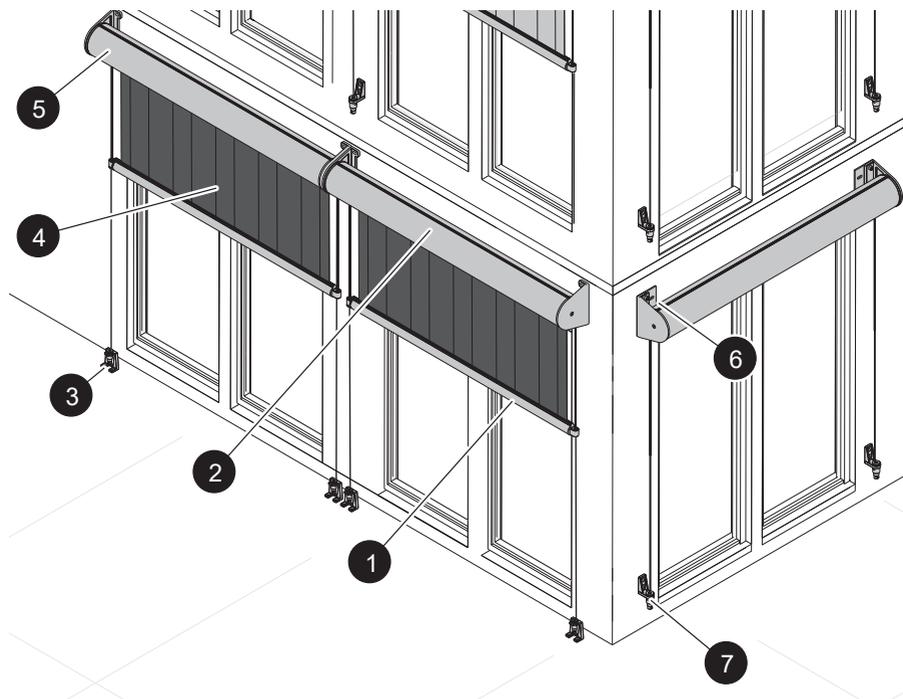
Vue d'ensemble du store vertical UNIVERSAL US3910
